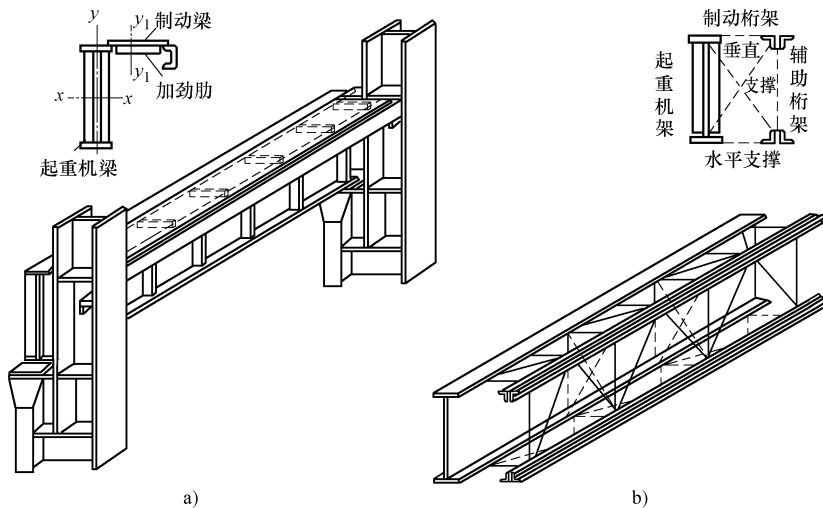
焊接起重机梁的截面形式和制动结构
